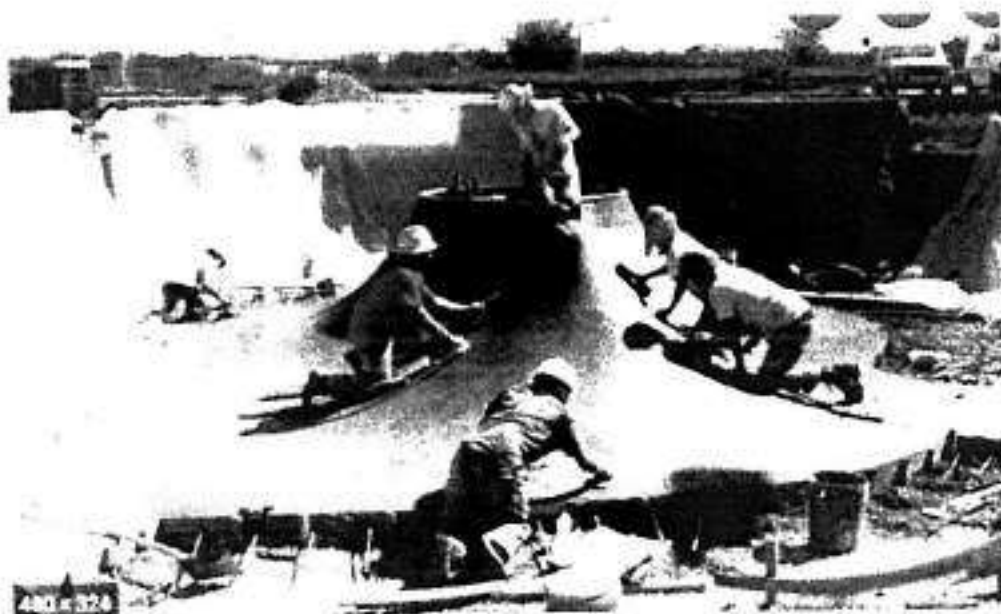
Profissionais executando a etapa final de alisamento do concreto.
